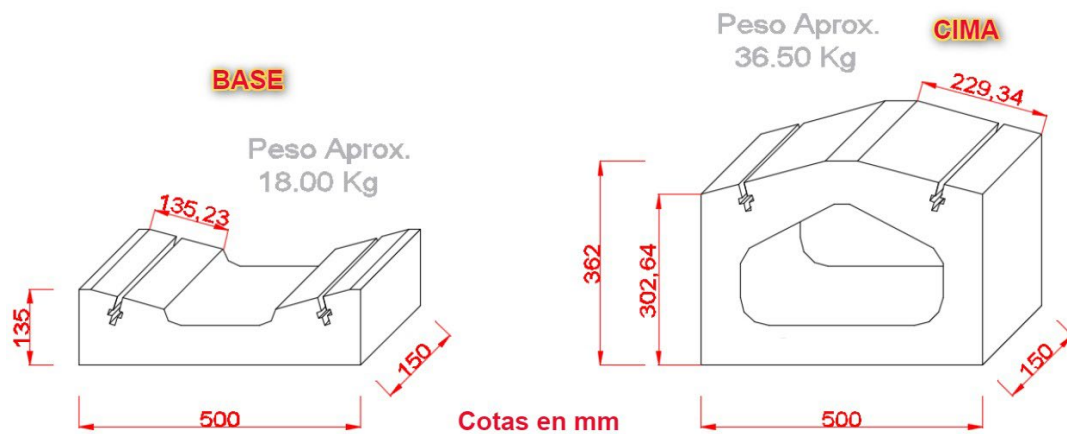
Prefabricados de hormigón para estructura sobre suelo
